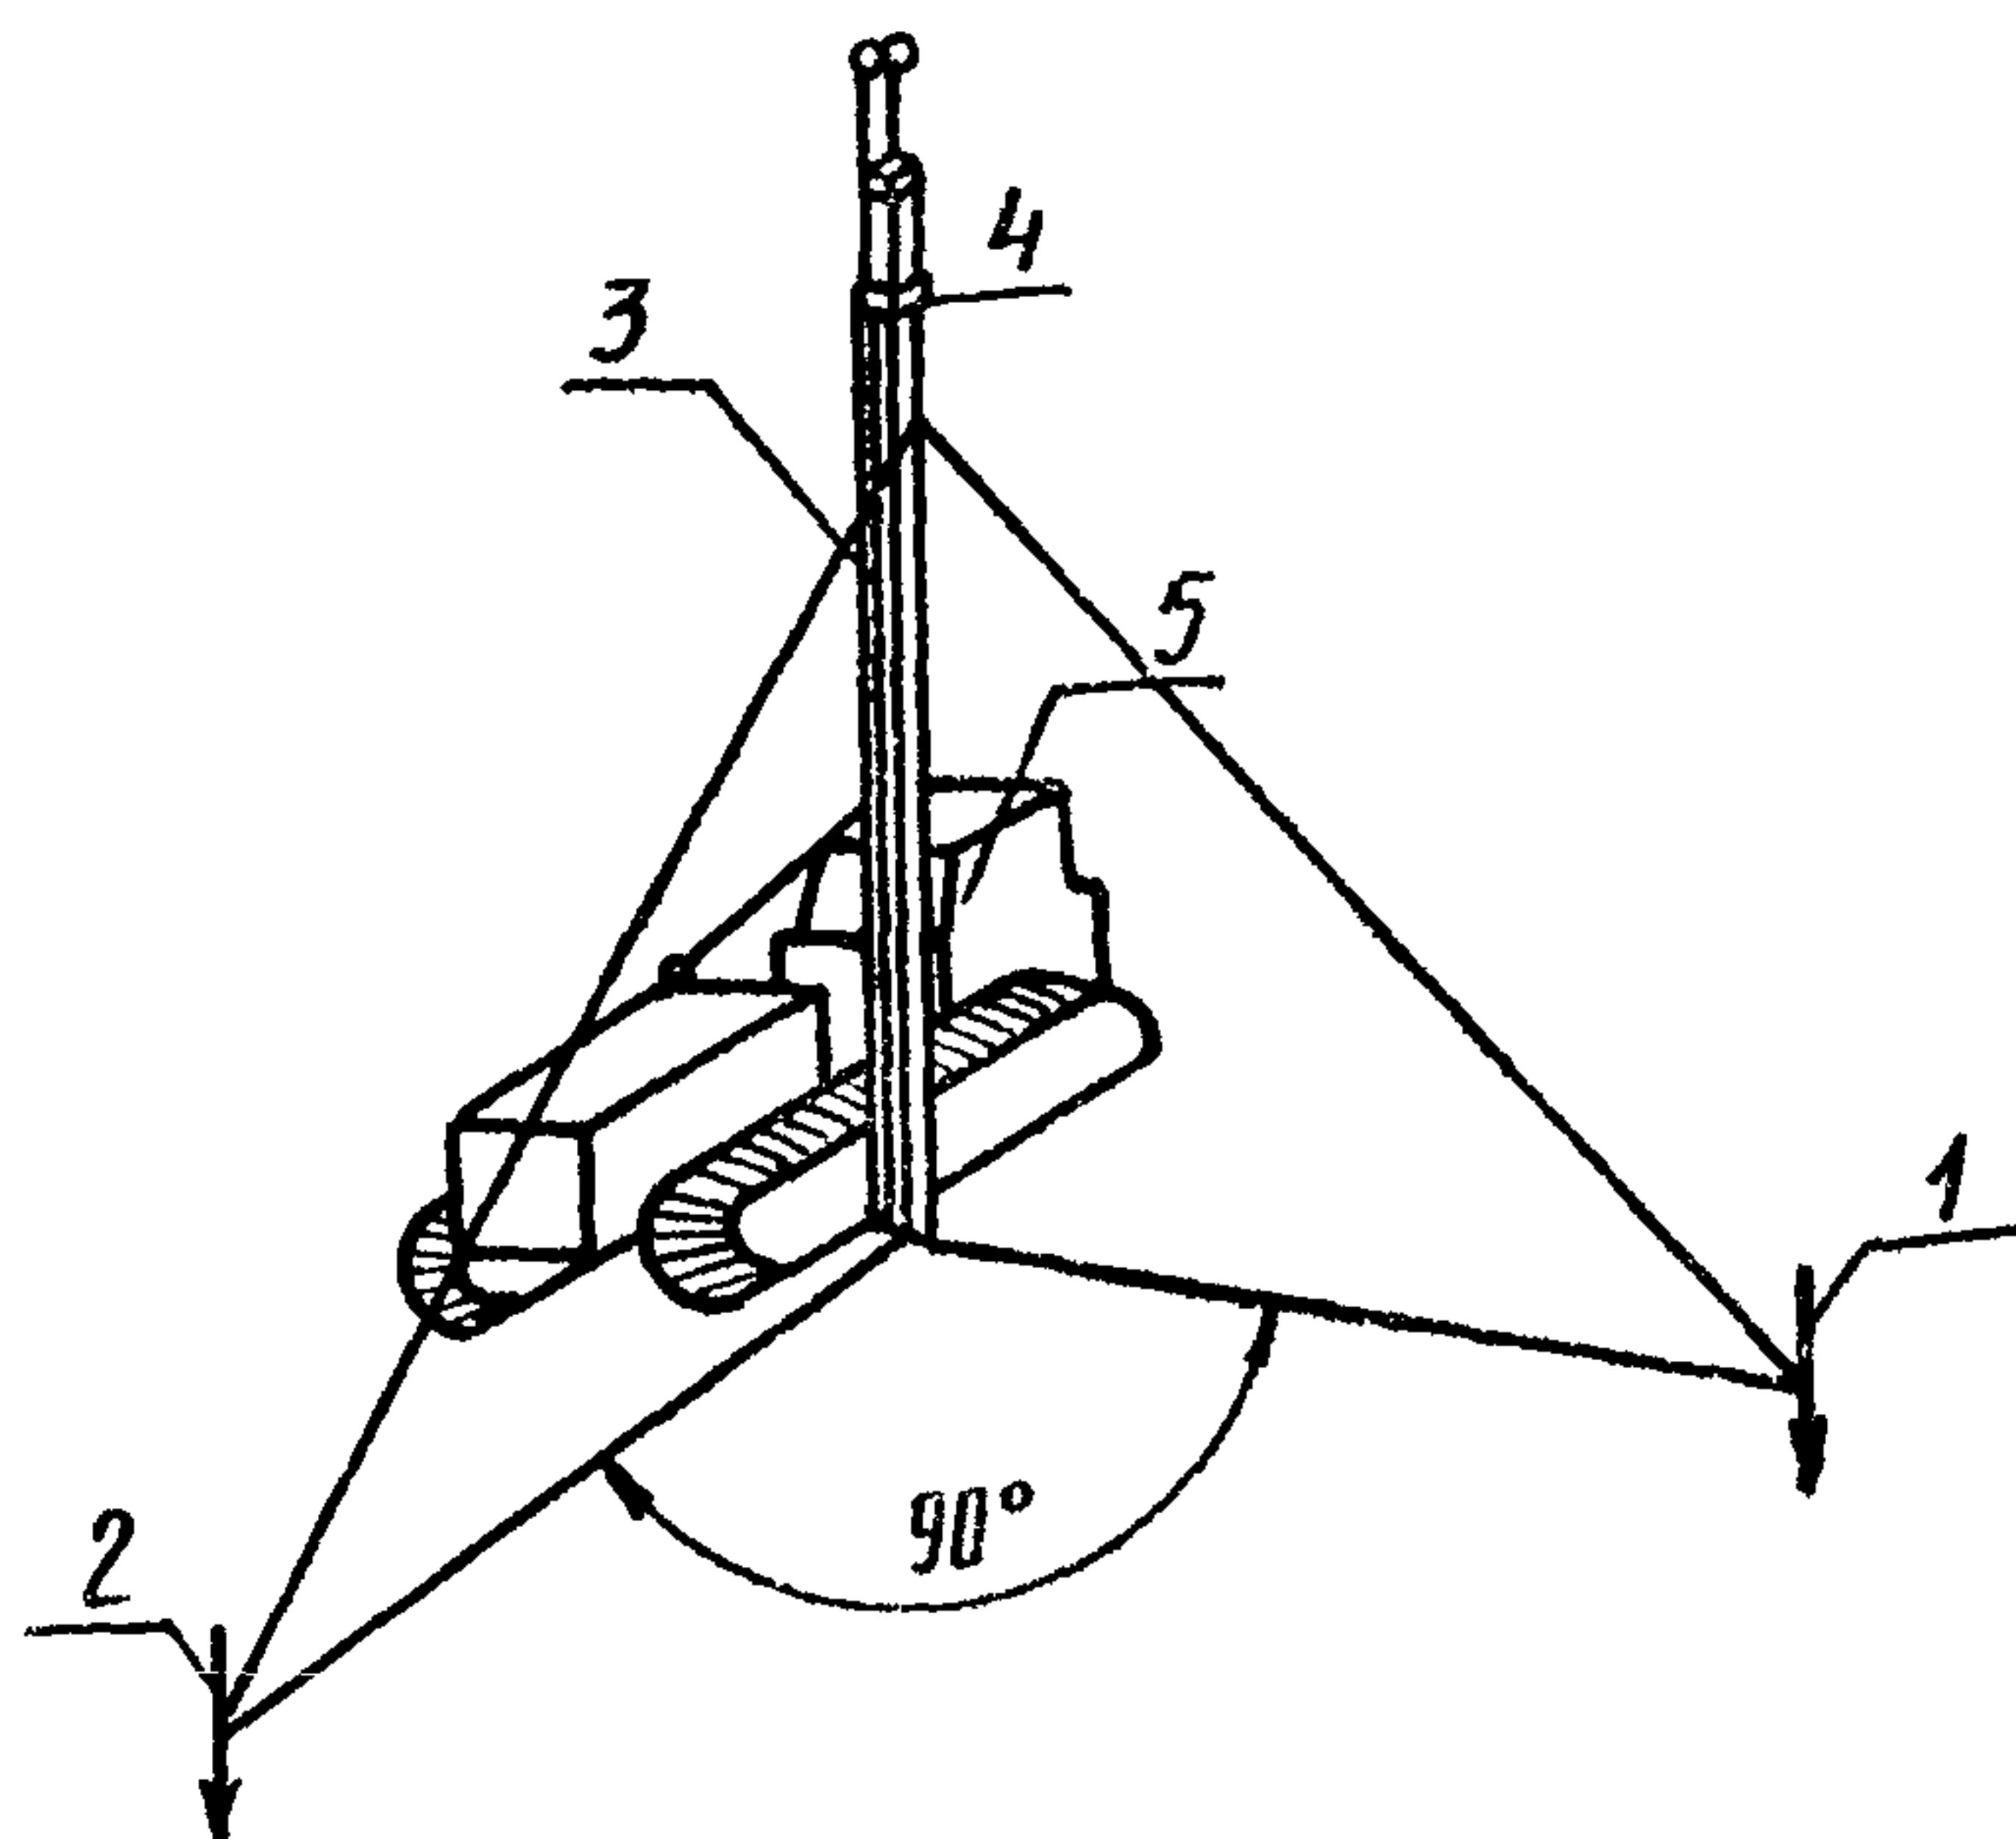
Рис. II. Схема выверки вертикальности сваи отвесами: 1-отвес закоперщика; 2-отвес копровщика; 3-свая; 4-оголовок; 5-сваебойный агрегат С-878М
